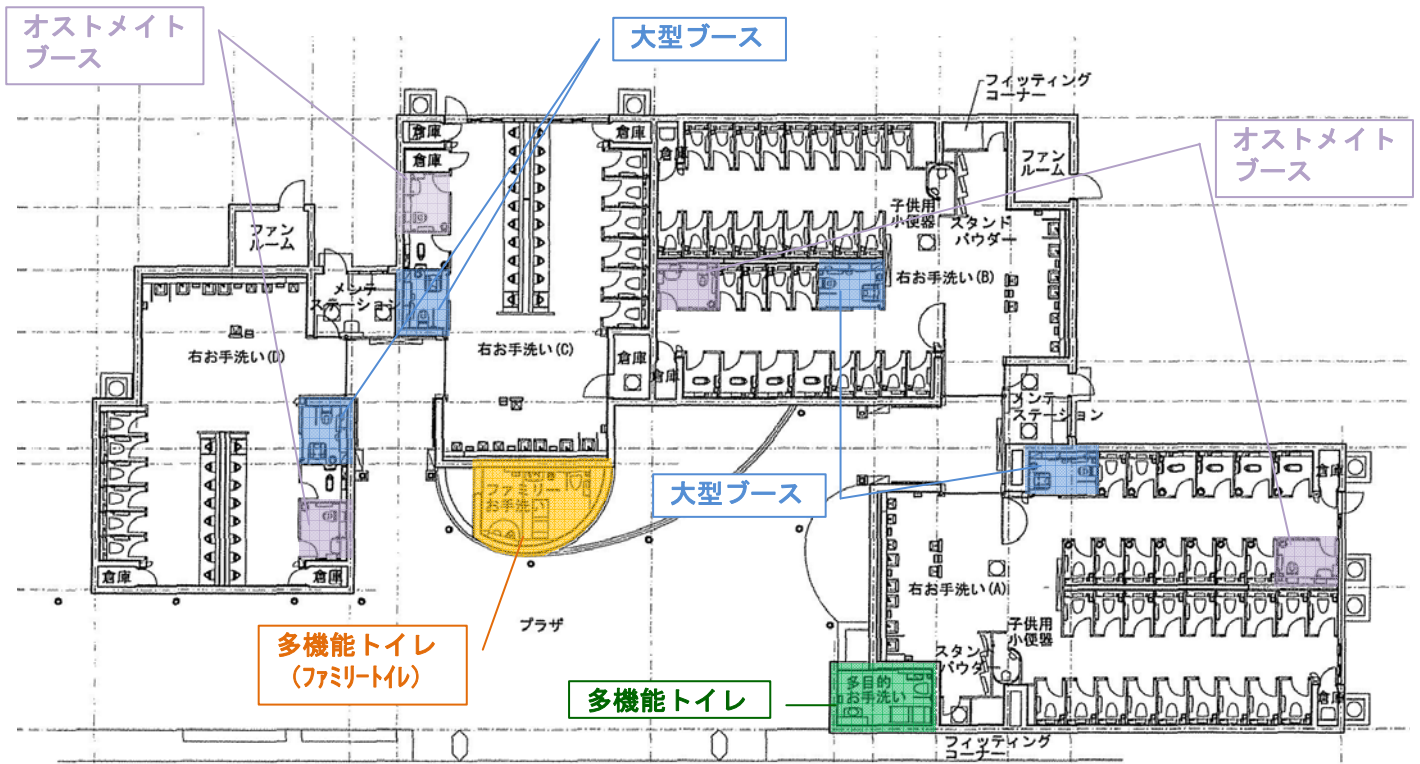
海老名 SA(下り)大型車側トイレ平面図
